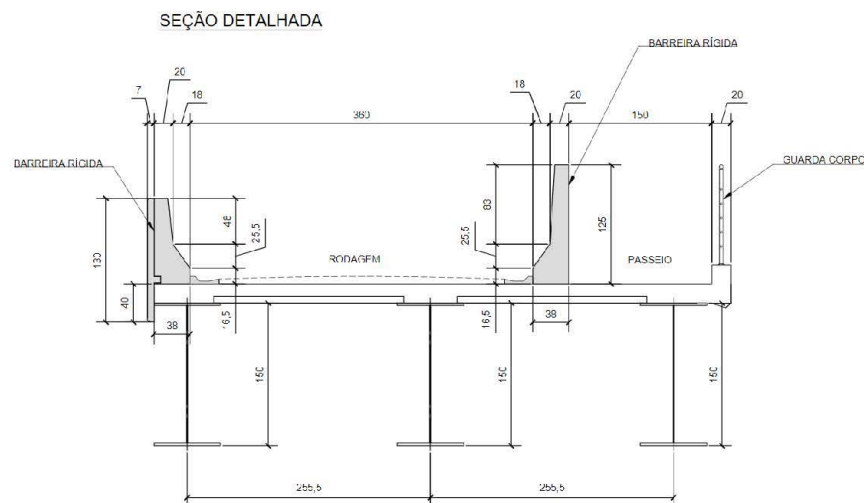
SEÇÃO TRANSVERSAL DETALHADA DA PONTE SOBRAGI
